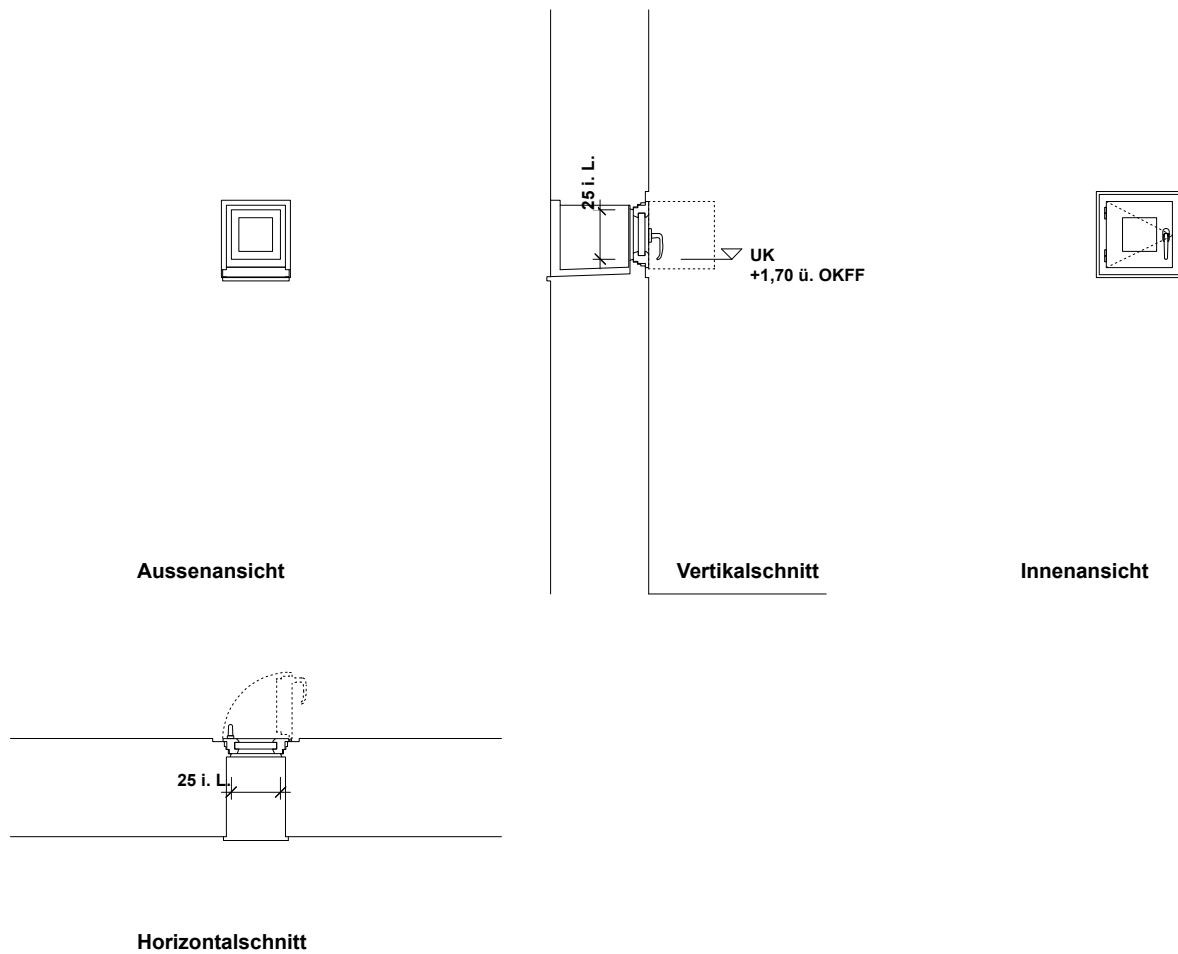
, Detailzeichnung der Fenster, ohne Maßstab, „Guckerl“, Gebäude Leichtbeton, Quelle: Tilmann Jarmer, TU München
